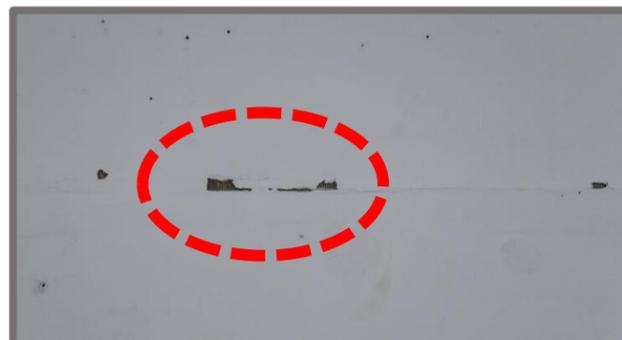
Desprendimiento de Tabla Yeso (Gypsum) en sección de pared de Tarima. Fuente: Autor.
